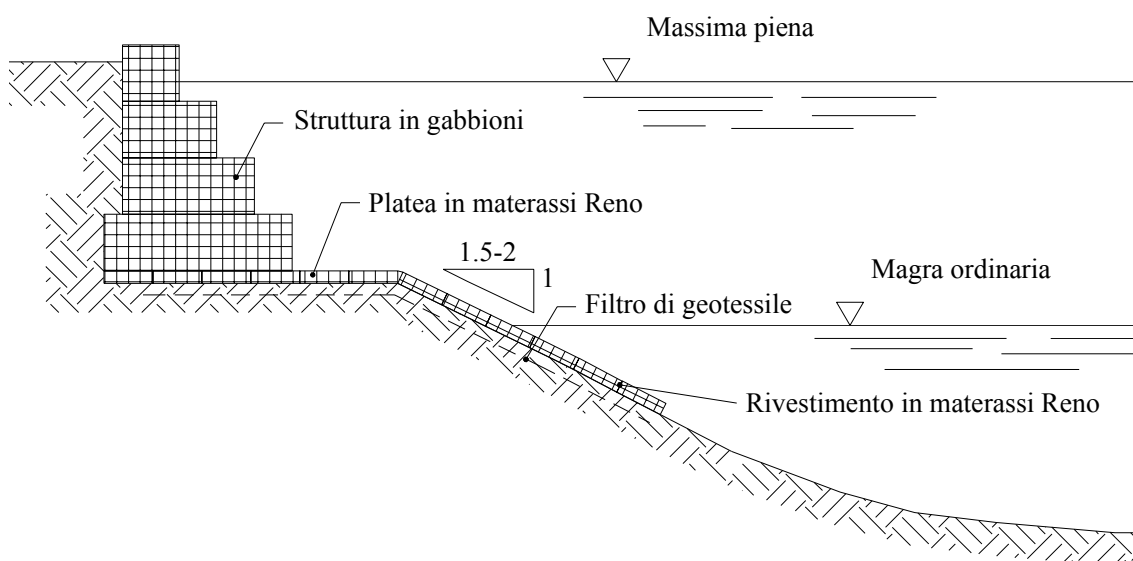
Protezione e contenimento di un rilevato mediante muro in gabbioni e fondazione in materassi Reno.
